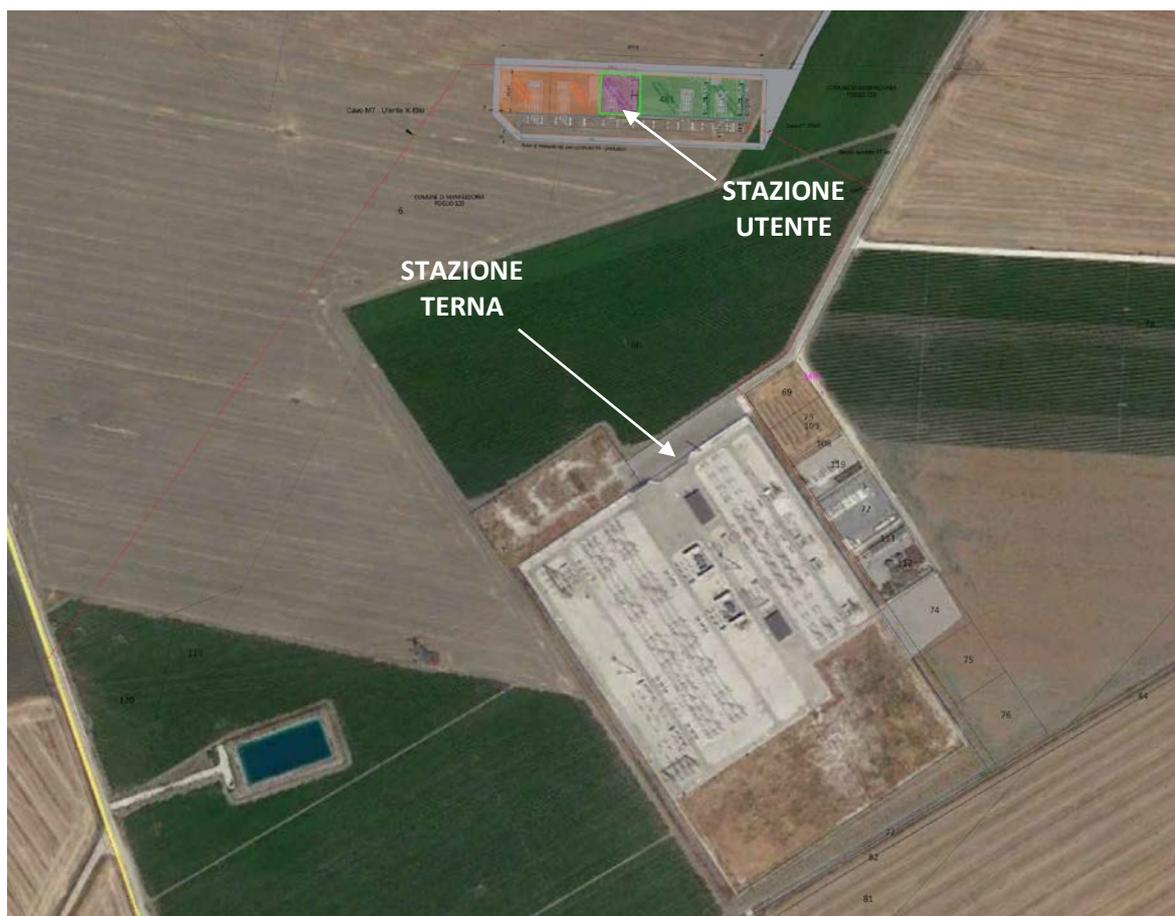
Stralcio elaborato di progetto STAZIONE UTENTE e STAZIONE TERNA
